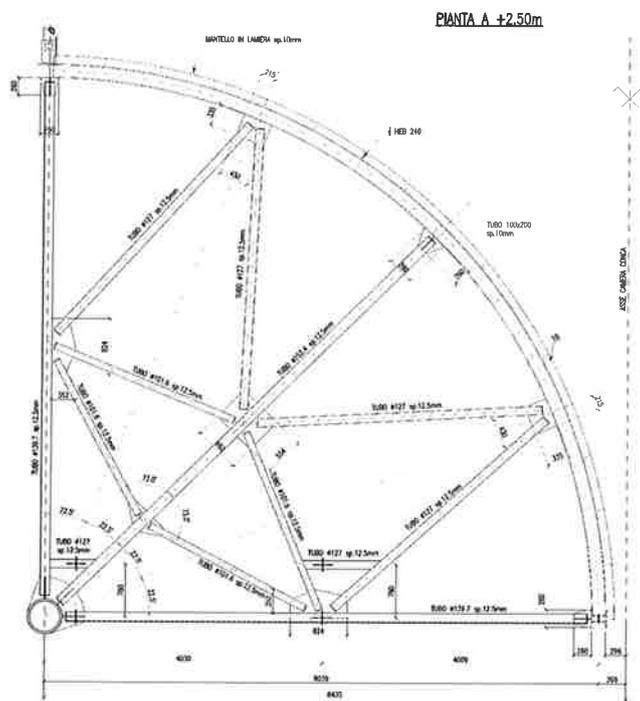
PIANTA TELAIO SPAZIALE A QUOTA +2.500 M
